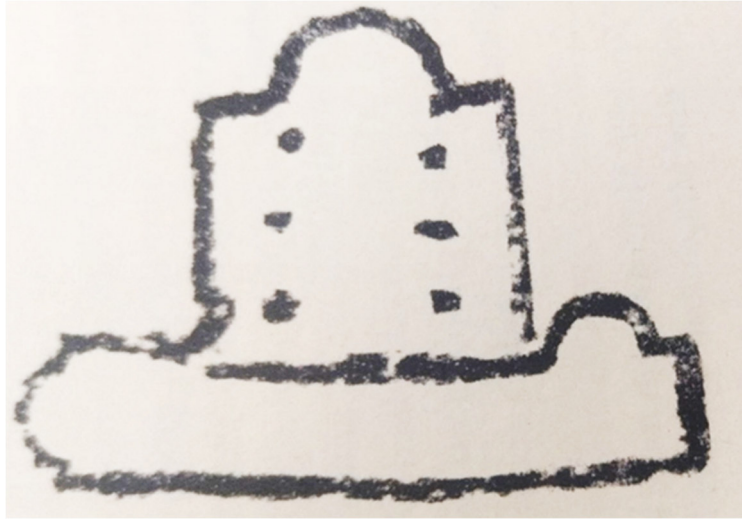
Ohrid’de tespit edilen en eski kilise planı çizimi (Ousterhout,2016)
